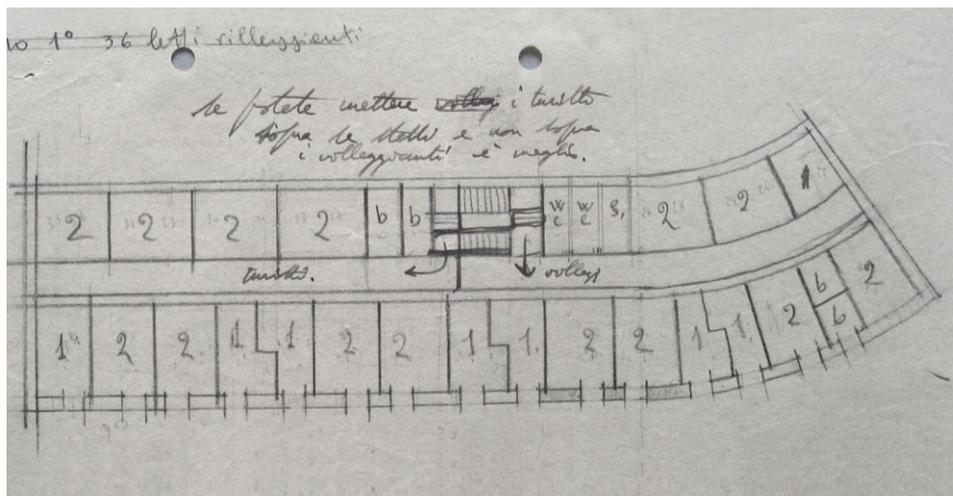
Grundriss 2.OG mit innen liegender Erschlieung
